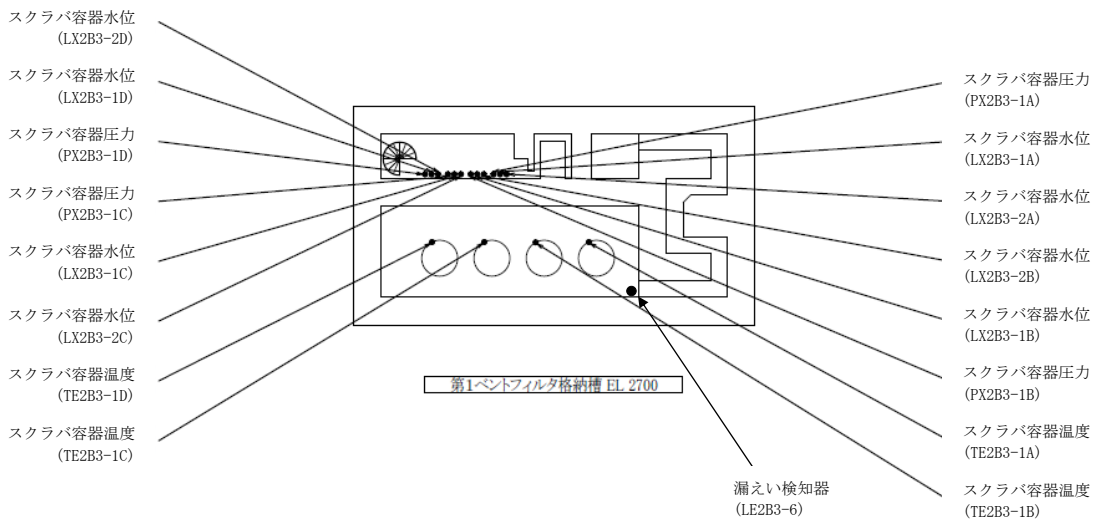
機器配置図 (第1ベントフィルタ格納槽) (3/3)
